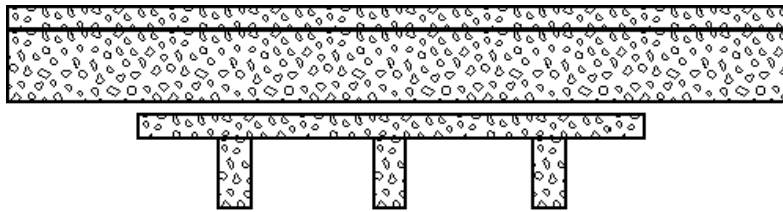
Puente de Vigas Armadas de Paso Alto. (*ingenierocivilinfo.com, 2015*)
